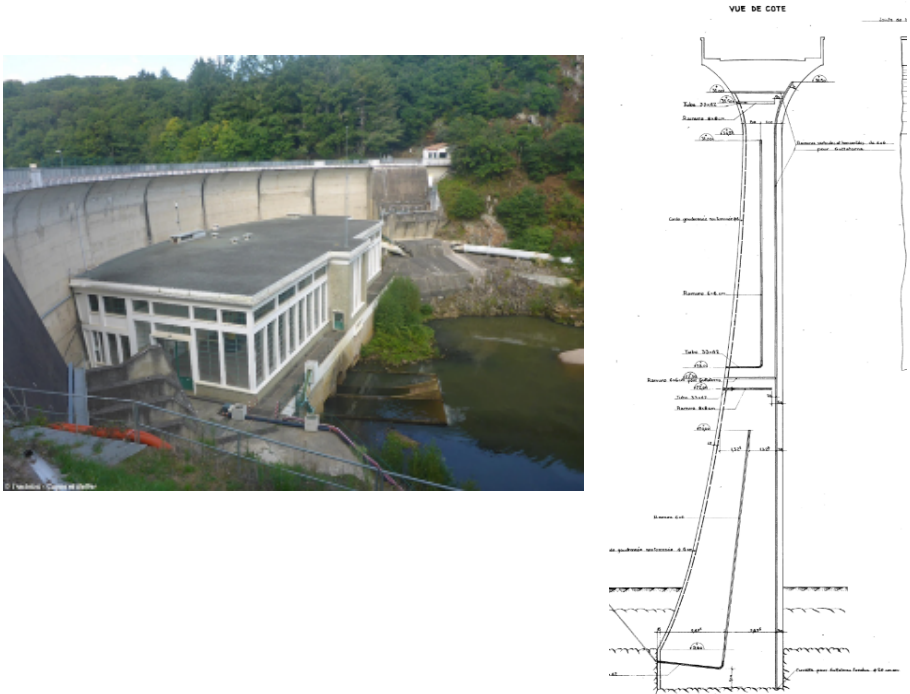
Photo du barrage de Mervent avant travaux de modernisation et coupe-type de la voûte.
